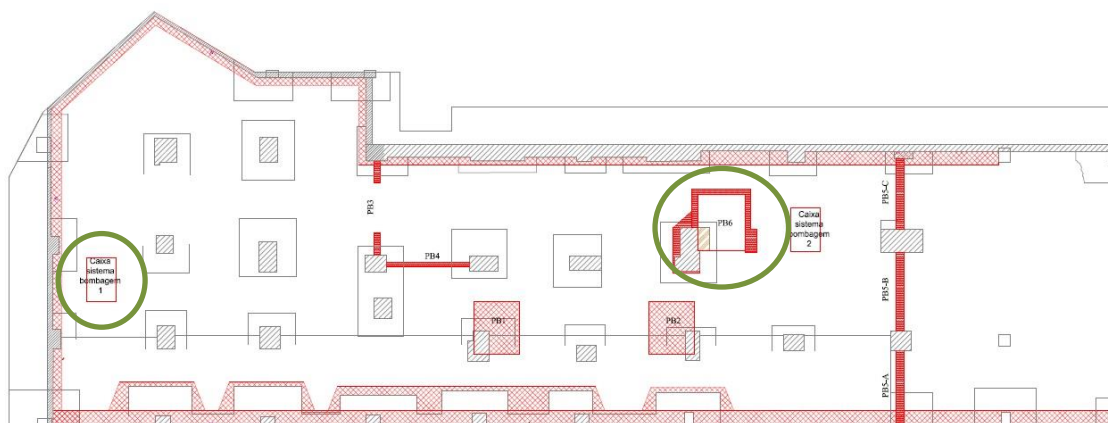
Planta da cave identificando os elementos executados posteriormente à execução da laje de ensoleiramento
